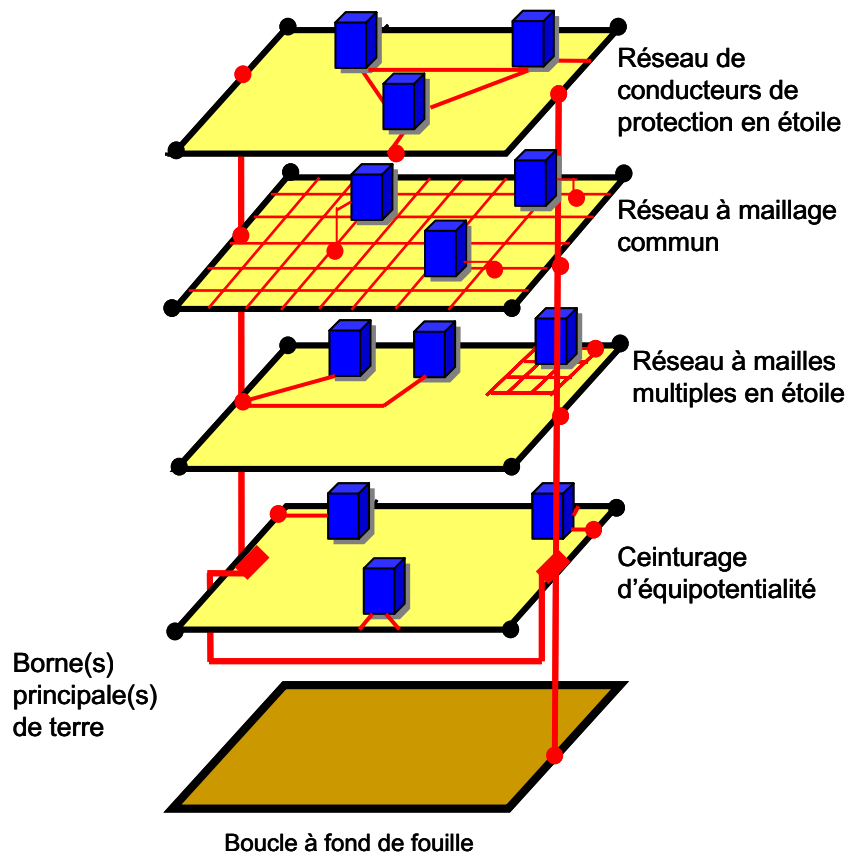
Exemple de ceinturage d'un bâtiment sans paratonnerre
